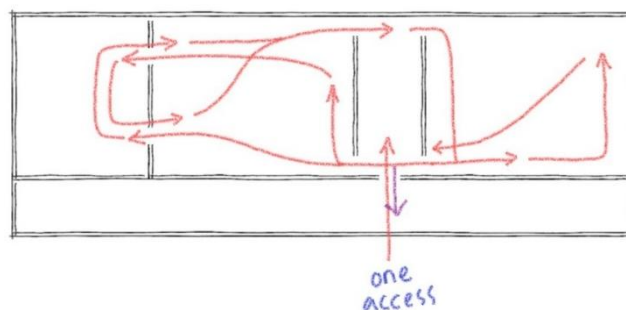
Alur Sirkulasi Gedung B Lantai 1
